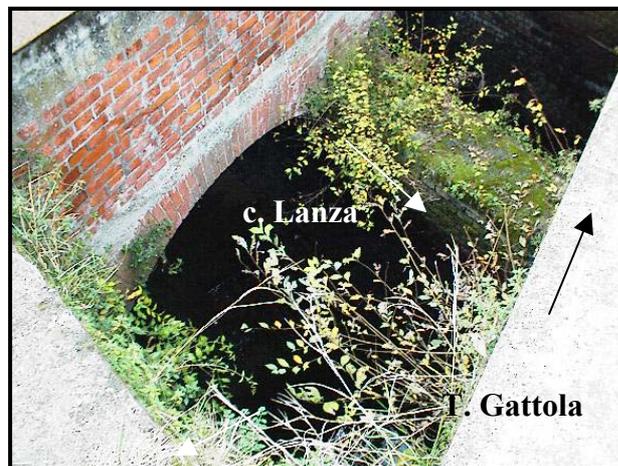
Vista dell’imbocco del sifone da monte e del primo ponte sul canale di Lanza.
